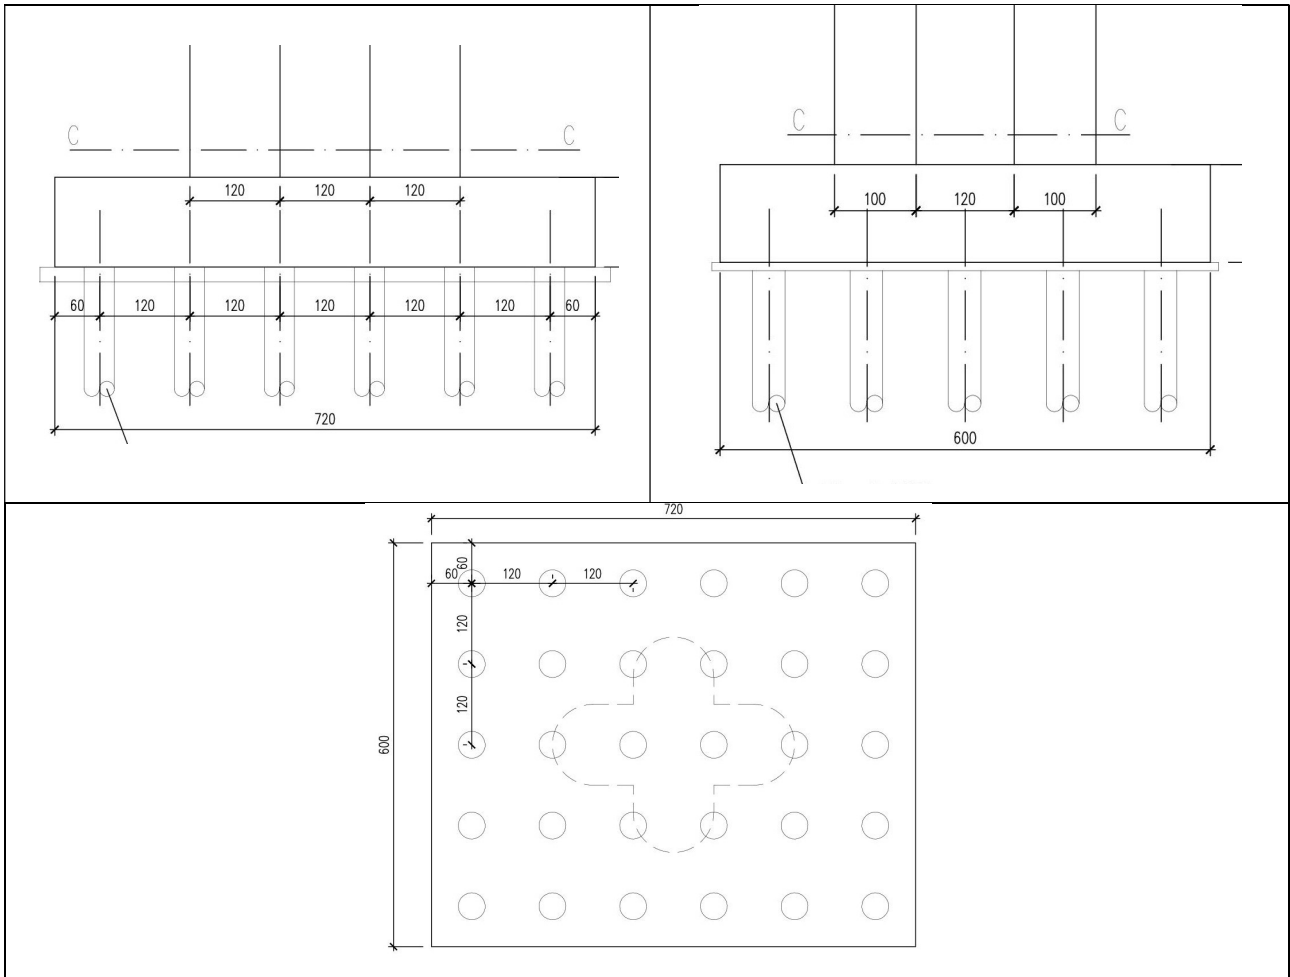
Plinto pila 2: vista frontale, vista laterale e pianta
